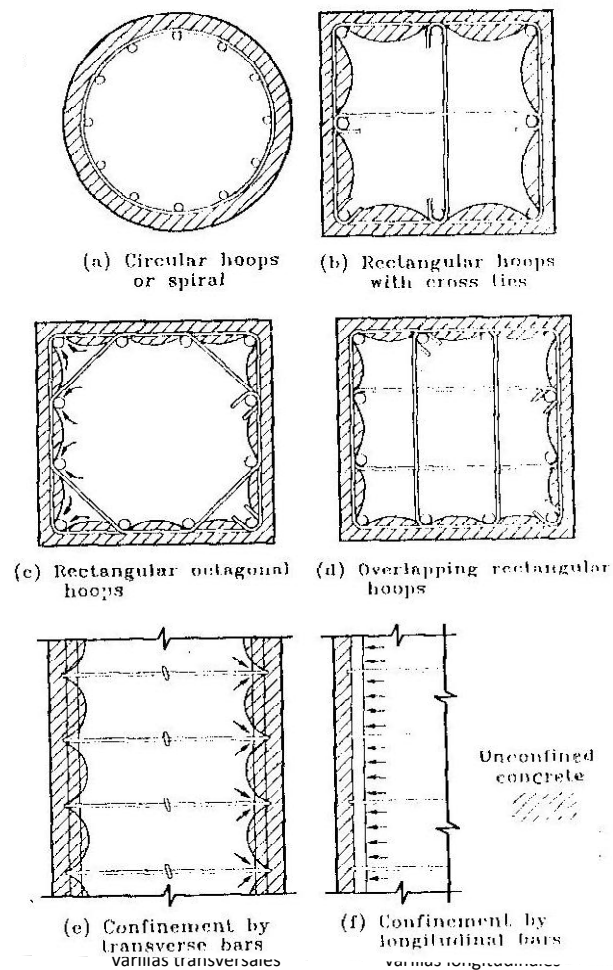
Confinamiento de secciones de columna con refuerzo transversal y longitudinal. (Tomado de Priestley, Seible y Calvi, 1996)
